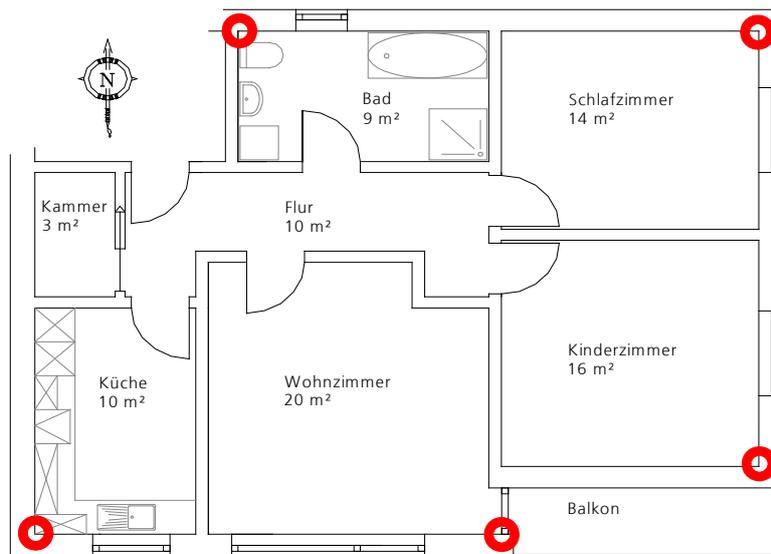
Grundriss der für die Berechnung ausgewählten 3-Zimmerwohnung. Markiert sind die dabei betrachteten Außenraumecken.
